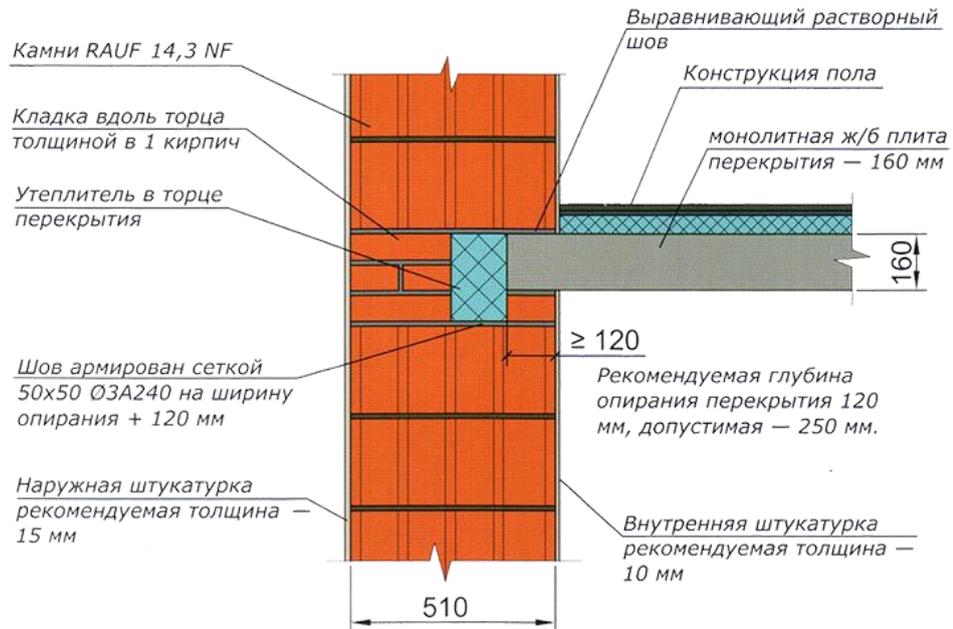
Узел междуэтажной плиты перекрытия [14]
